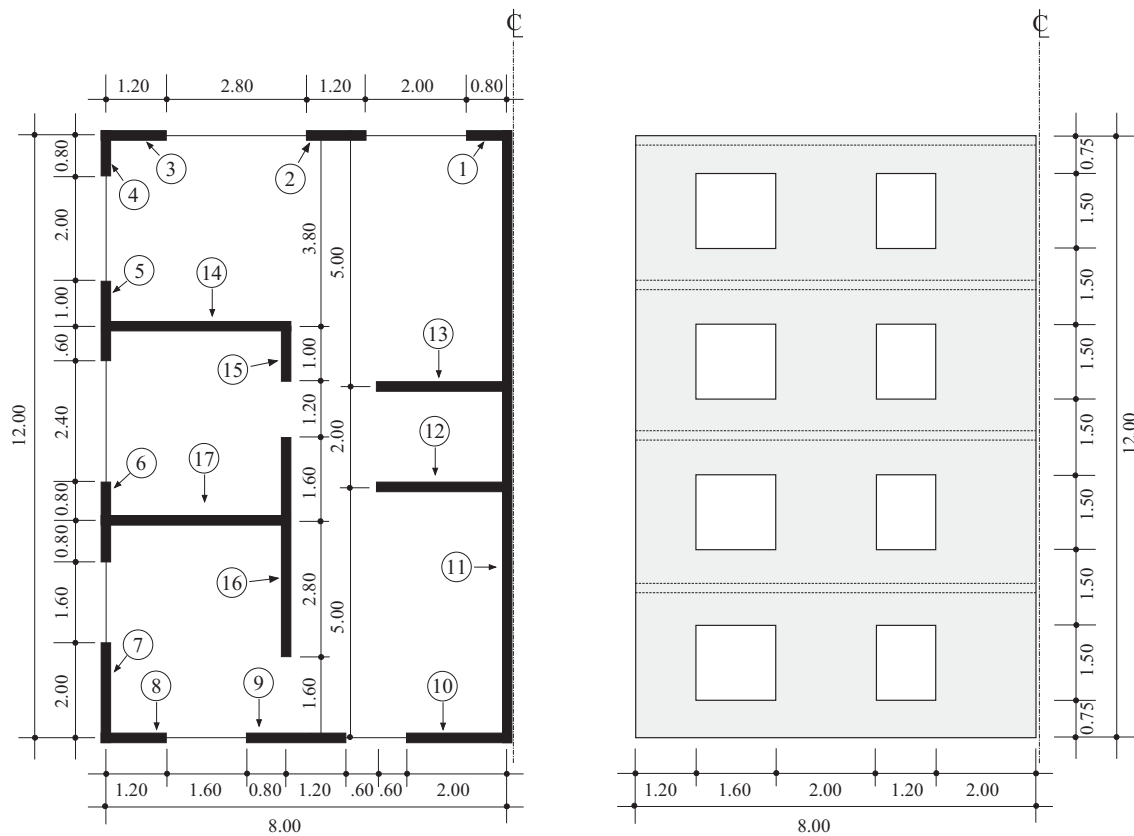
Grundriss und Ansicht des vierstöckigen Beispielgebäudes, Abmessungen in m
